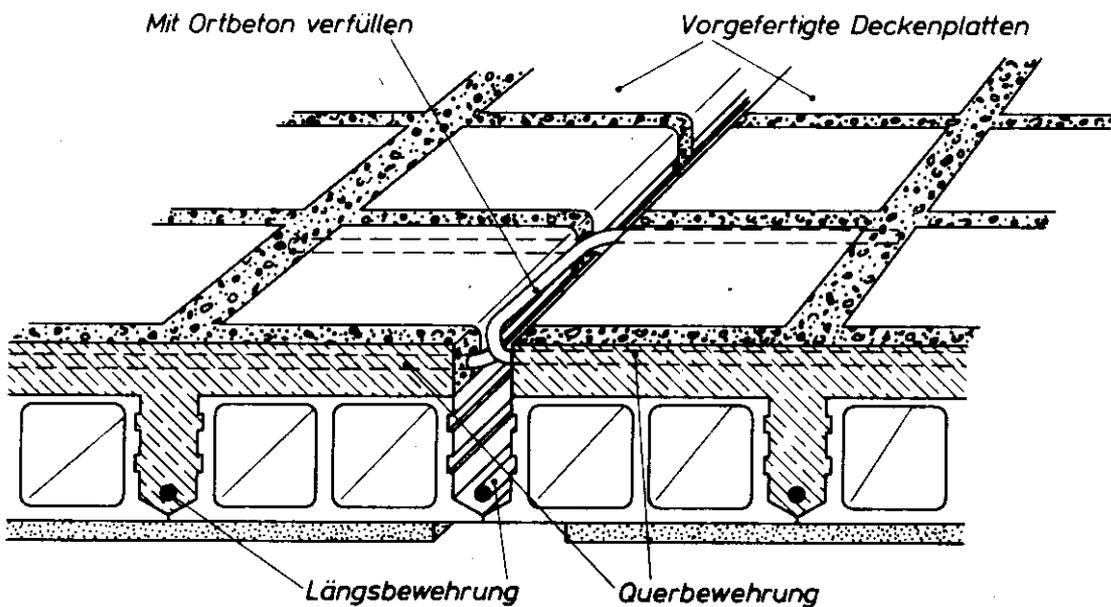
Verbindung zweier Deckenplatten aus Ziegeln mit teilvermörtelbaren Stoßfugen nach DIN 4159; Stoß mit abgebogener Querbewehrung
